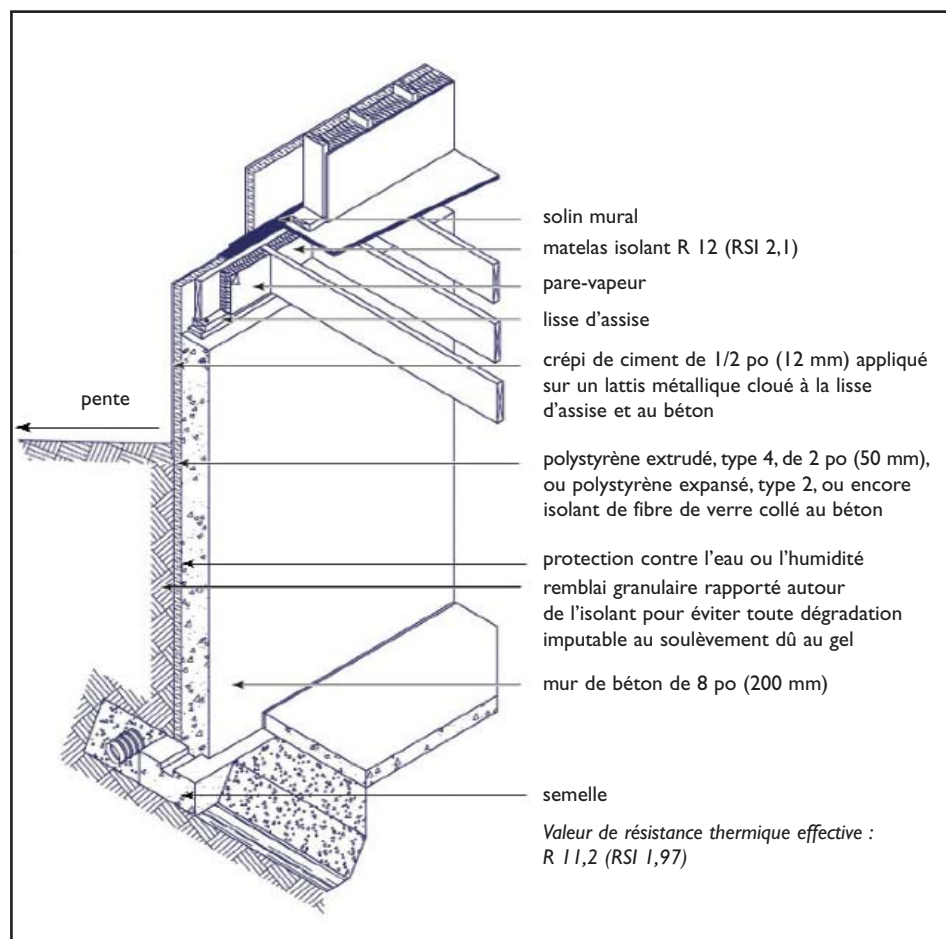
Mur de fondation en béton isolé sur sa face extérieure
